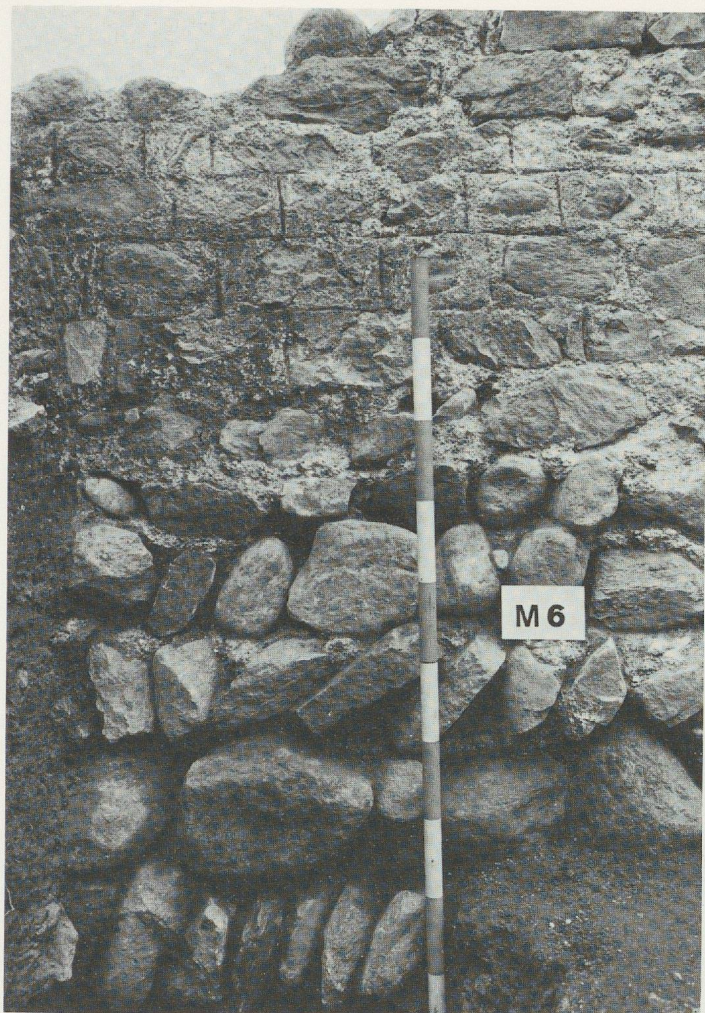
Bât. est : parement nord du mur M6, vue sud.
